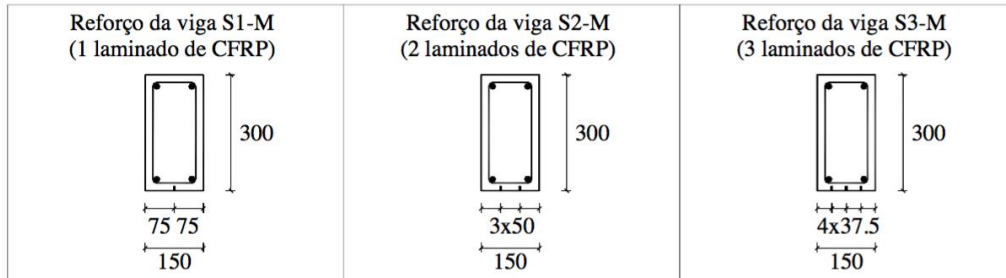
Seção transversal das vigas reforçadas de DIAS *et al.* (2012)
